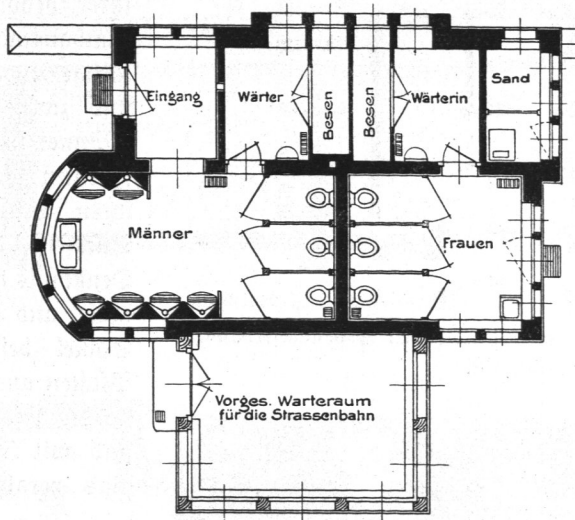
Bedürfnisanstalt mit Wartehalle Meßberg, Grundriß.
